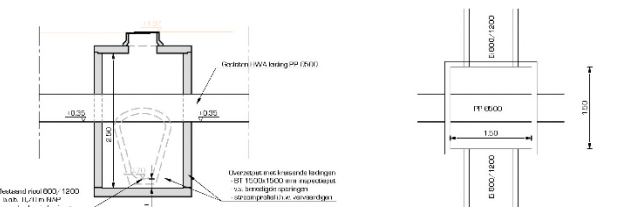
Detail HWA doorsteek Reitdiepstraat - Ø500 mm (U2)
